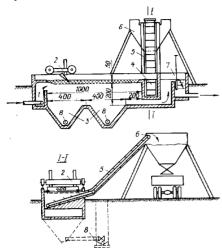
, Флотационный шерстежироулавливатель (для кожевенных заводов) производительностью  $150\ ss^3/a$ : I— прымное отделение; 2— скребок-тележка; 3— бункера для осадка: 4— шлемоприемник; 5— ковшовый транспортер;  $\delta$ — бункера для илома 27— регулятор уровая воды на выпуске; 8— выпуск осадки:
